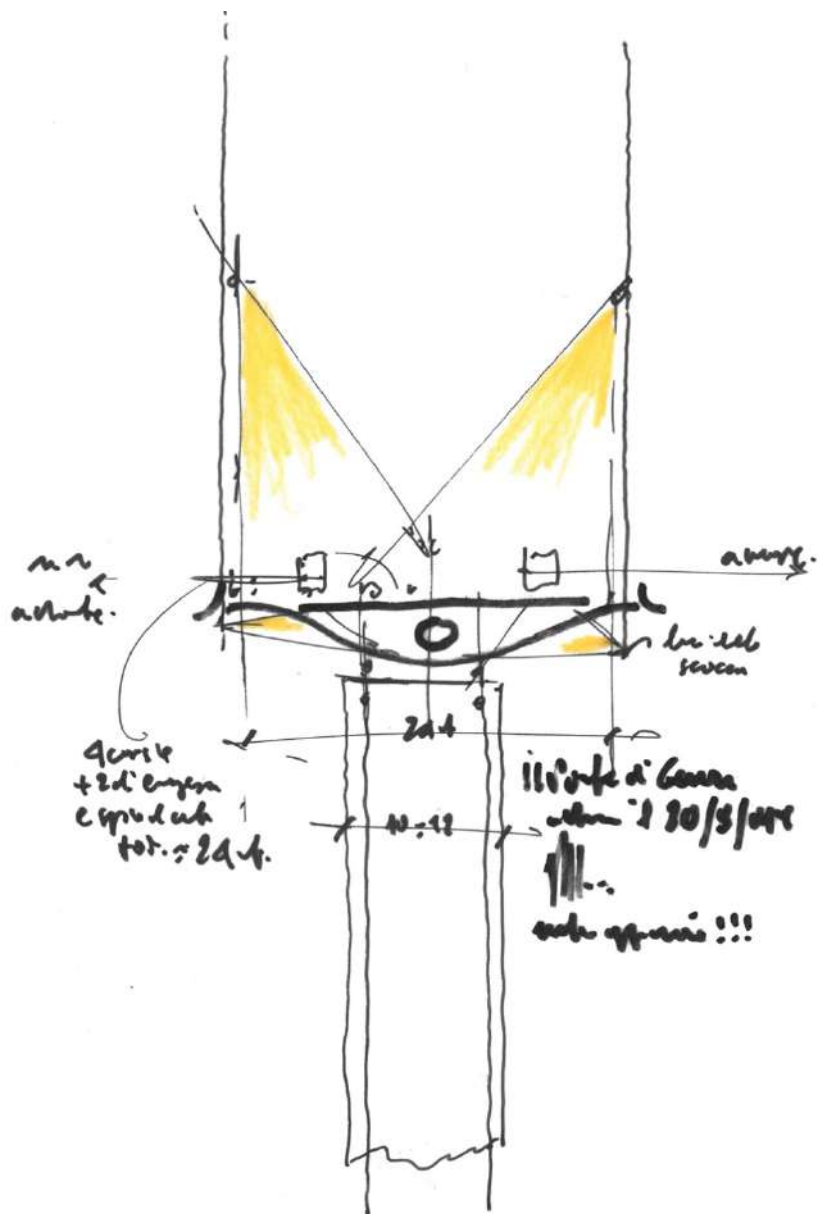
Croqui arquitetônico do Renzo Piano, mostrando estrutura e iluminação preliminares. Fonte: Renzo Piano Building Workshop
